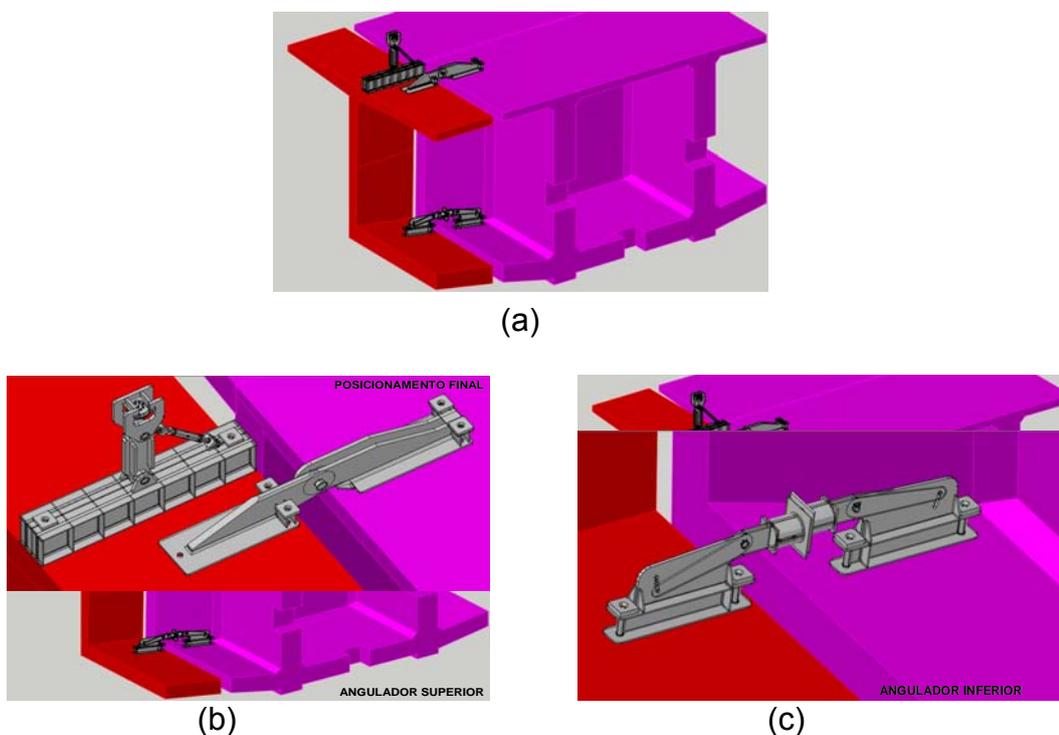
Equipamentos de içamento no posicionamento final. (a) Ajuste transversal. (b) Detalhe do angulador superior. (c) Detalhe do angulador inferior.
